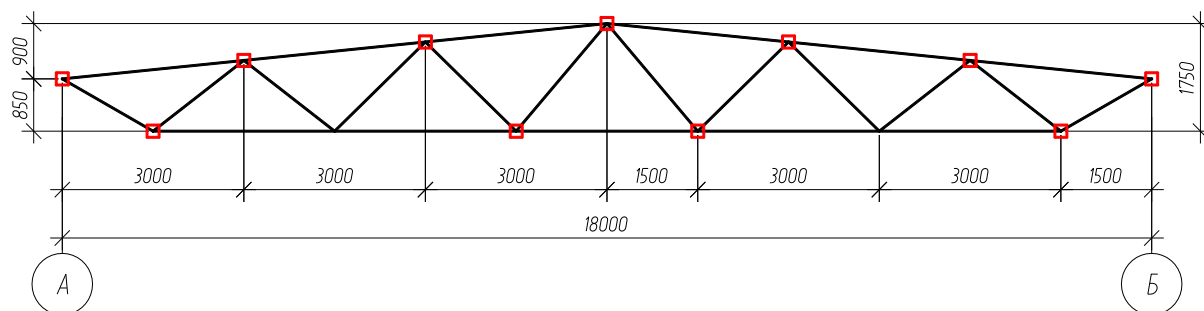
Геометрическая схема фермы (красным показано раскрепление фермы из плоскости)
